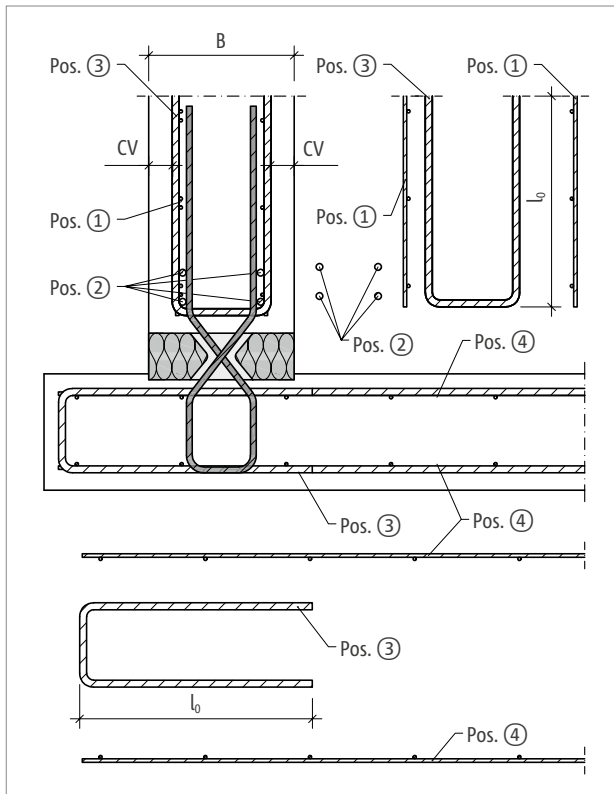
Schöck Sconnex® type W-NT-B: Bijlegwapening bij trekkrachtverankering; met vloerplaat gelijklopende steunbalk als voorbeeld
